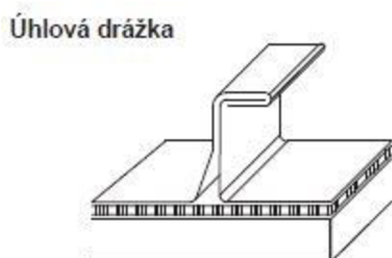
Plech opatřen úhlovou drážkou (zdroj: [12])
